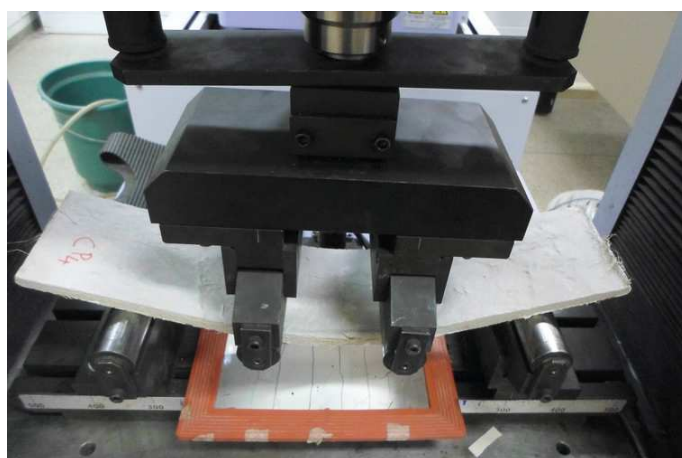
Ensaio de flexão 4 pontos de laminado
